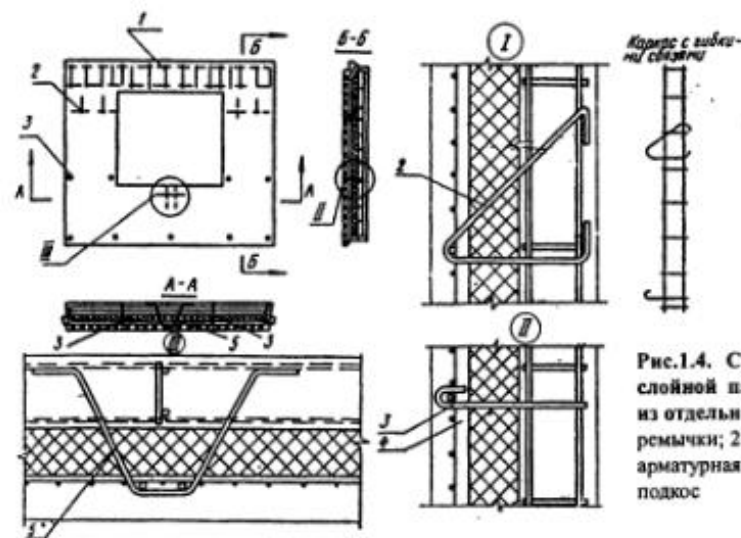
Схема армирования трехслойной панели с гибкими связями из отдельных стержней: 1 - каркас перемычки; 2 - подвеска; 3 - распорка; 4 - арматурная сетка наружного слоя; 5 - подкос
